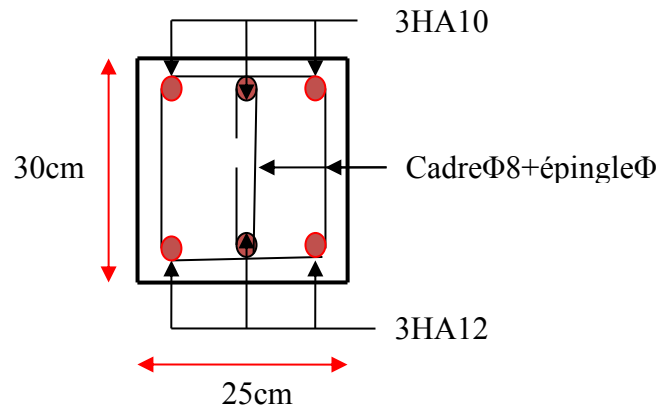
Schéma de ferrailage de la poutre de chaînage
